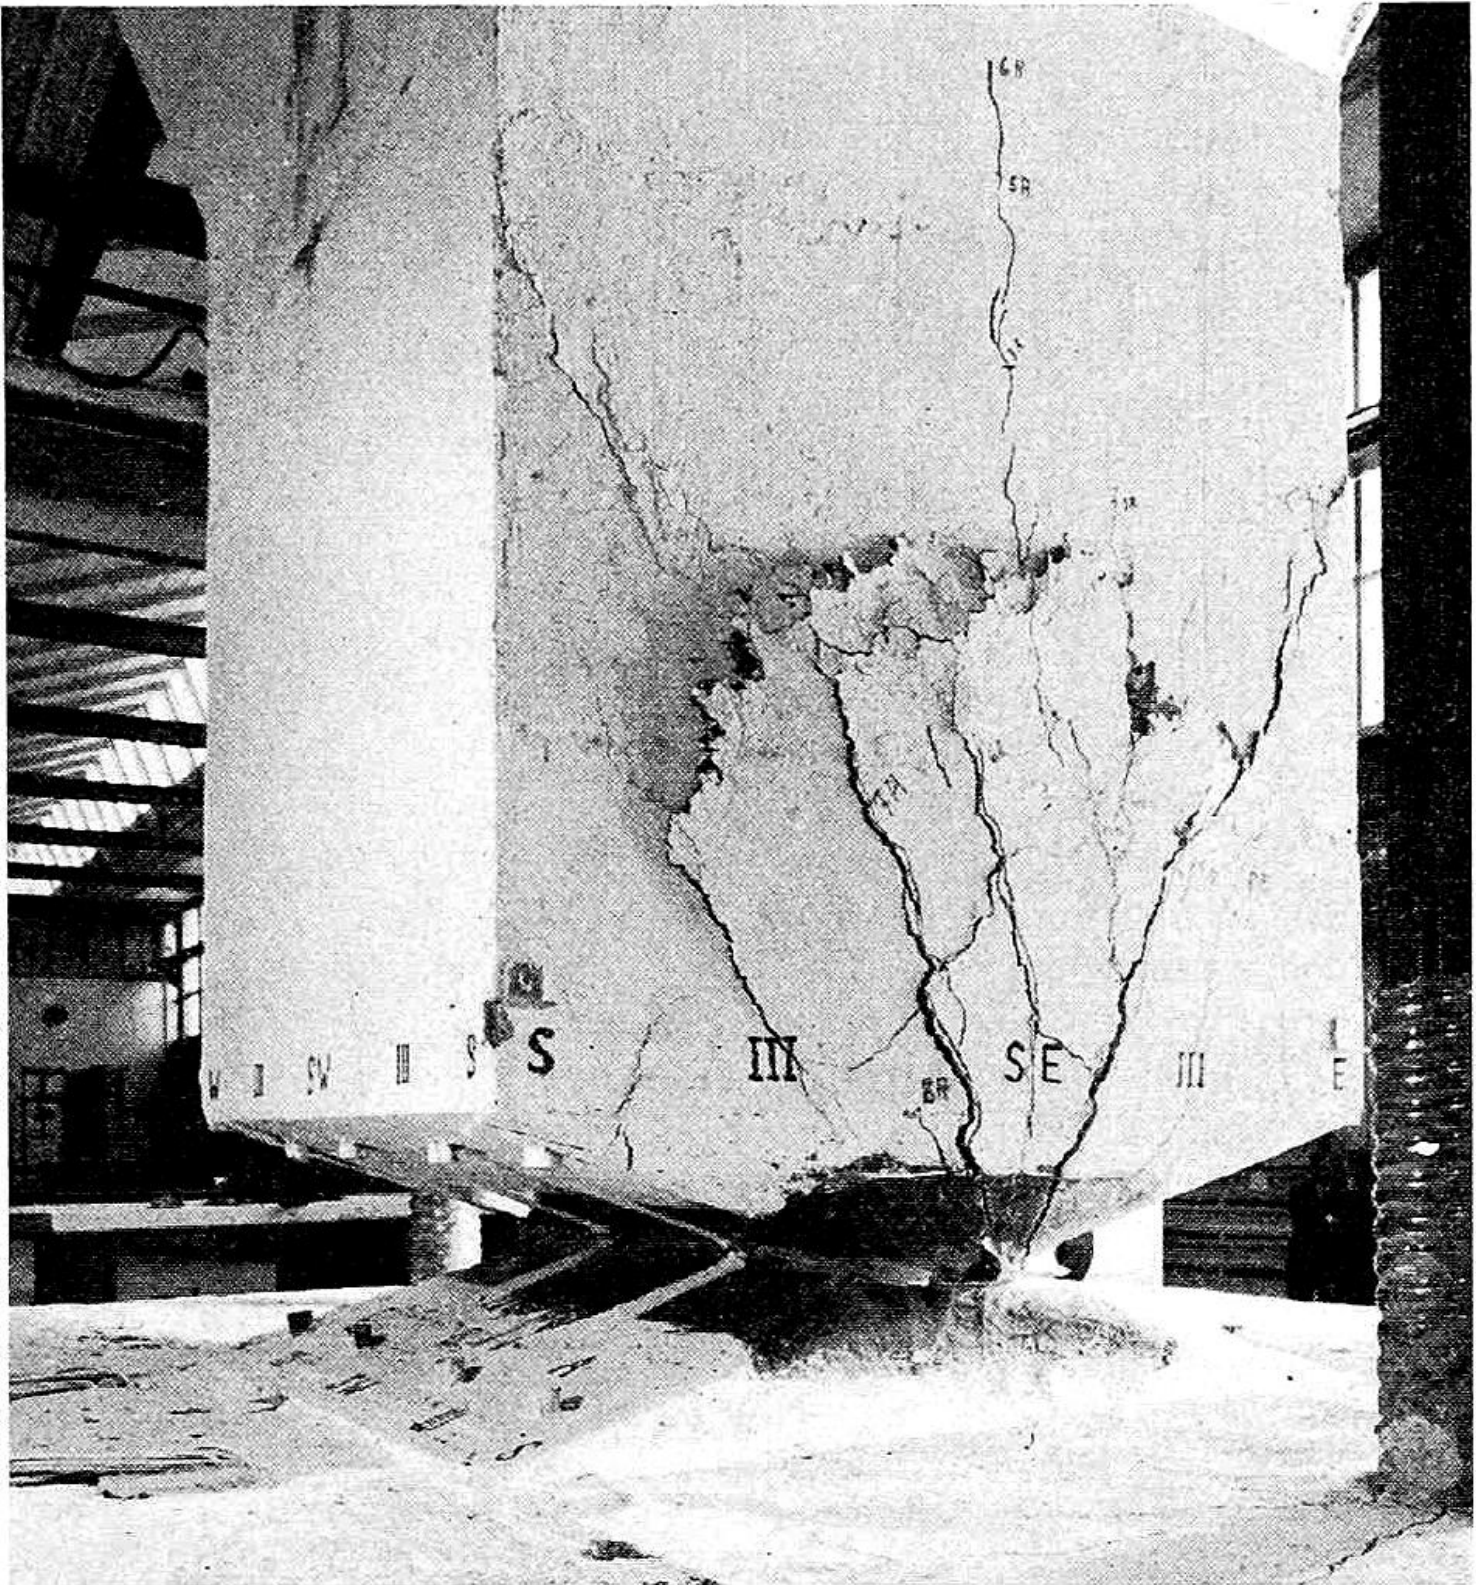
Betongelenk nach Erreichen der Bruchlast von 1610 t, mit klaffenden Quersugrissen und Aufbauchen des Betons infolge Ausknicken der Gelenkstähle im Stützenkopf
